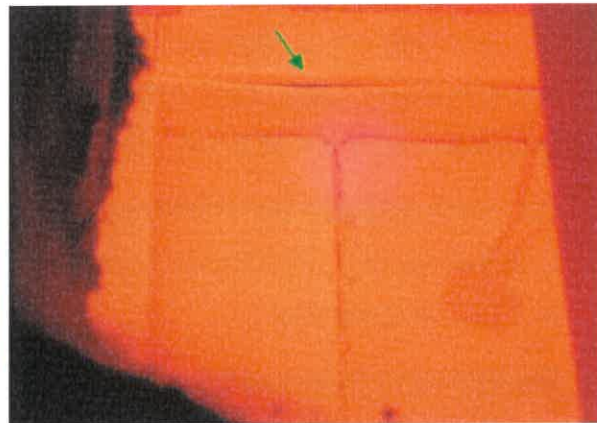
Prüfminute 60: Erste Plattenlage löst sich an den Vertikalfugen. Horizontale Bekleidung des Deckenanschlusses löst sich weiter.
